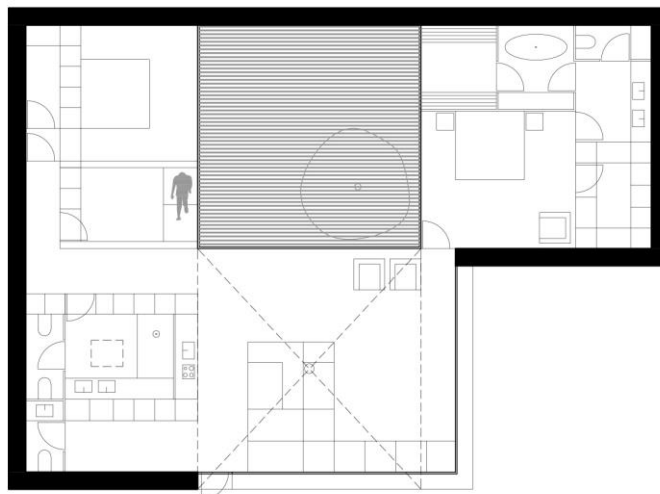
Planta de proposta para projeto Casa de Férias S.
